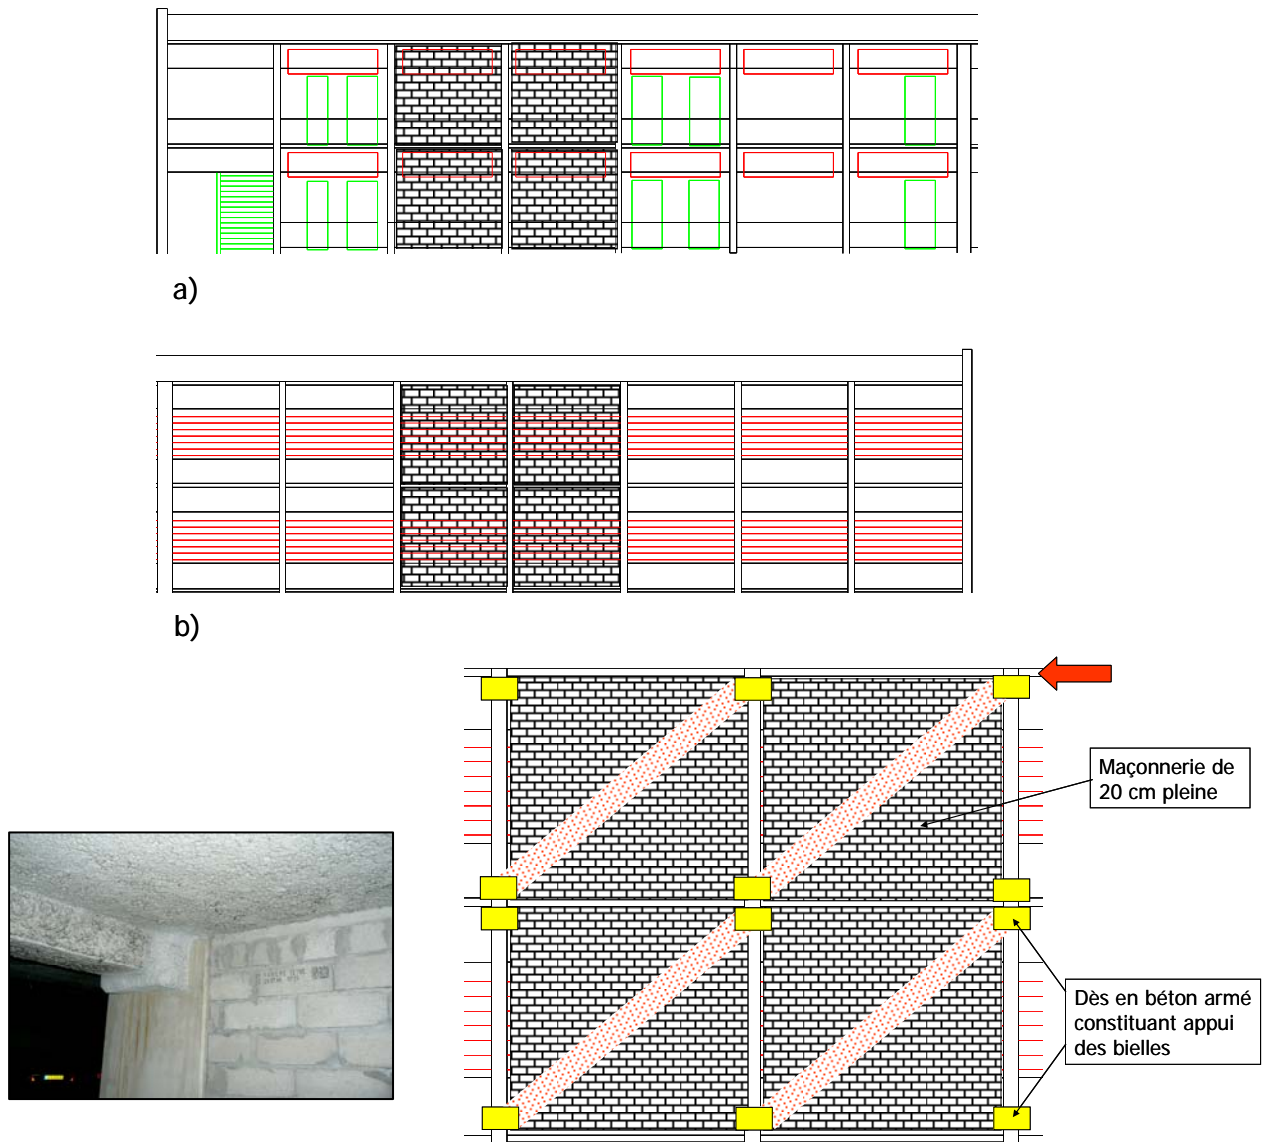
Renforcement par panneaux de maçonnerie et dès d'appui aux extrémités des poteaux
